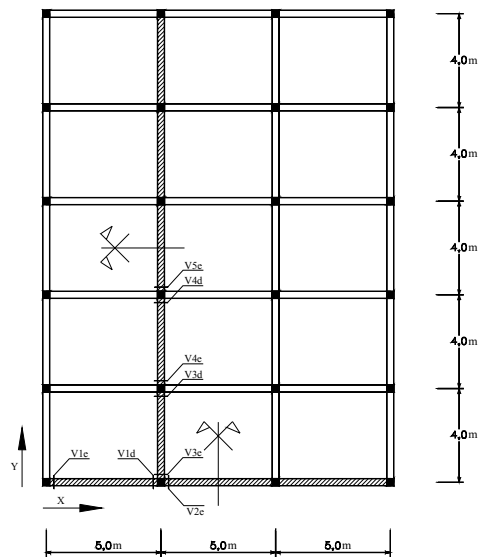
Secções das vigas considerados para a pormenorização de armaduras apresentada.
